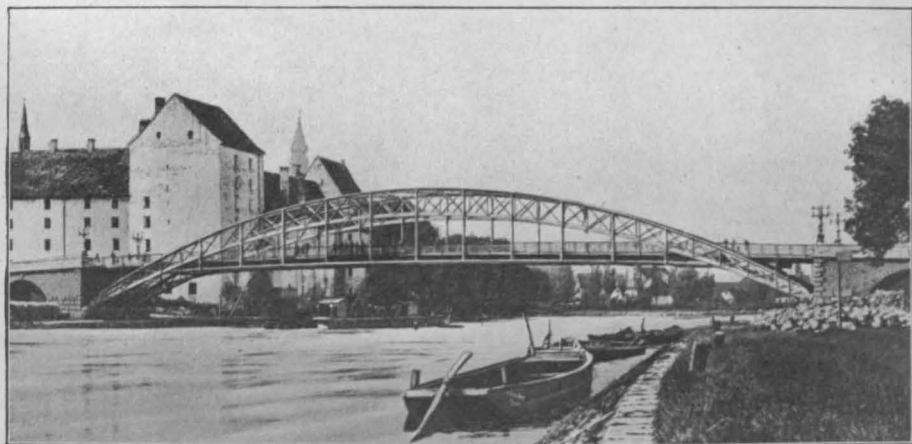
Straßenbrücke über die Donau in Straubing. 1896. Stützweite 91 m.
